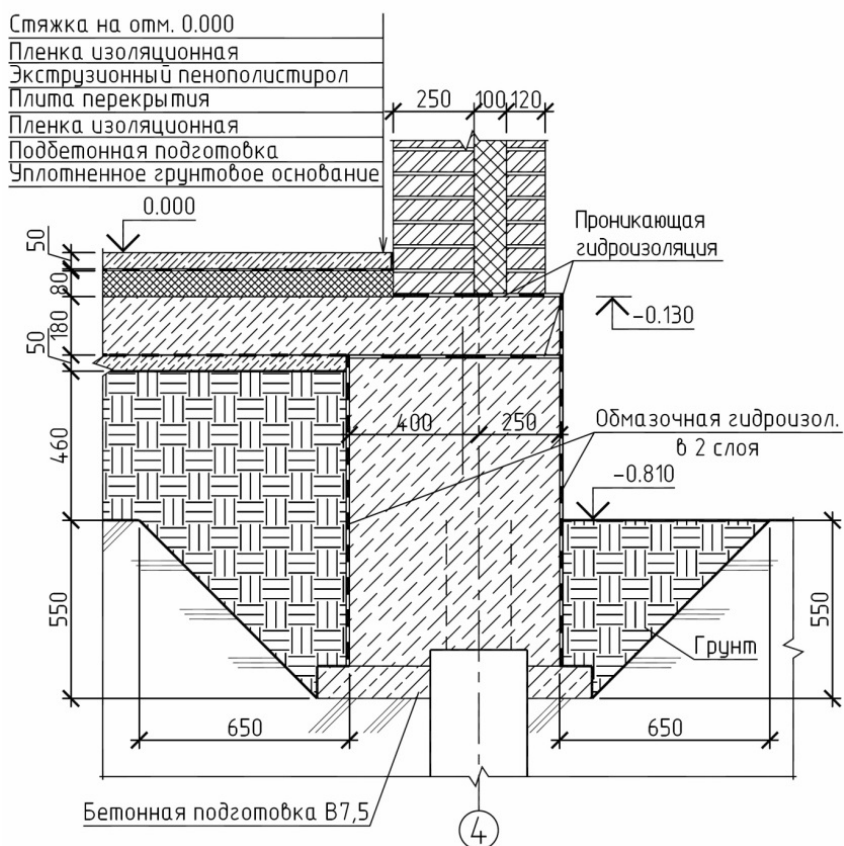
Обратная засыпка несущих конструкций и их защита
